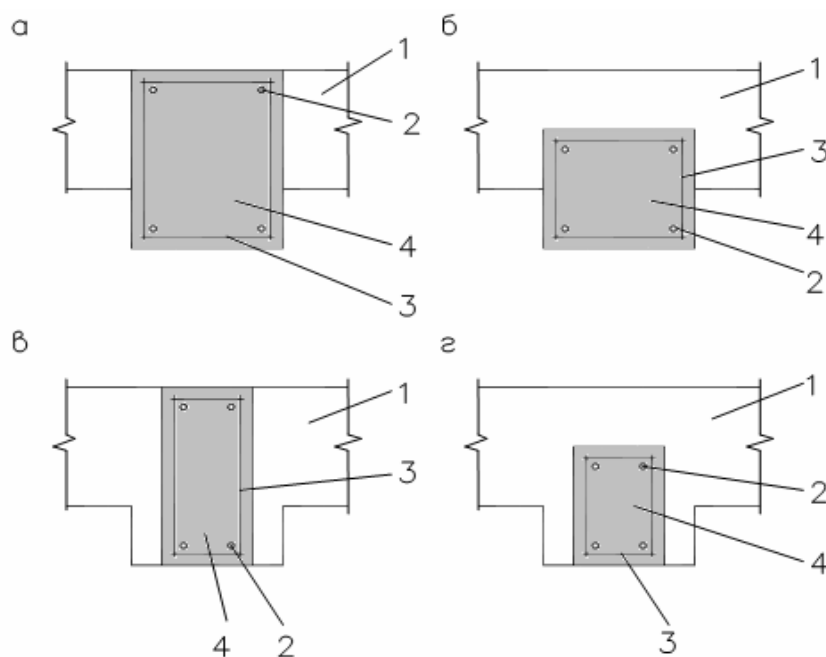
Усиление простенков с пилястрами монолитными железобетонными элементами: а, в – сквозная пробивка стены; б, г – устройство углублений с одной стороны: 1 – усиливаемая кладка, 2 – продольная арматура, 3 – поперечная арматура, 4 – бетон усиления
